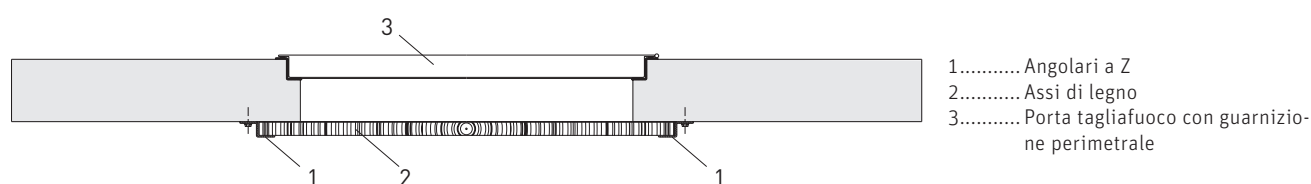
Esempio di installazione della porta di un magazzino, vista in pianta
